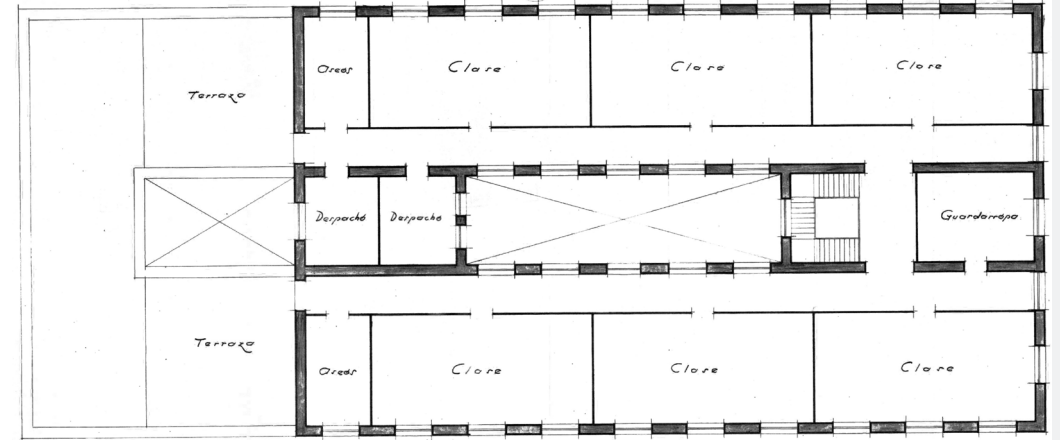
, Planta Alta Grupo Escolar. Intervención 1951, Antonio Serrano
